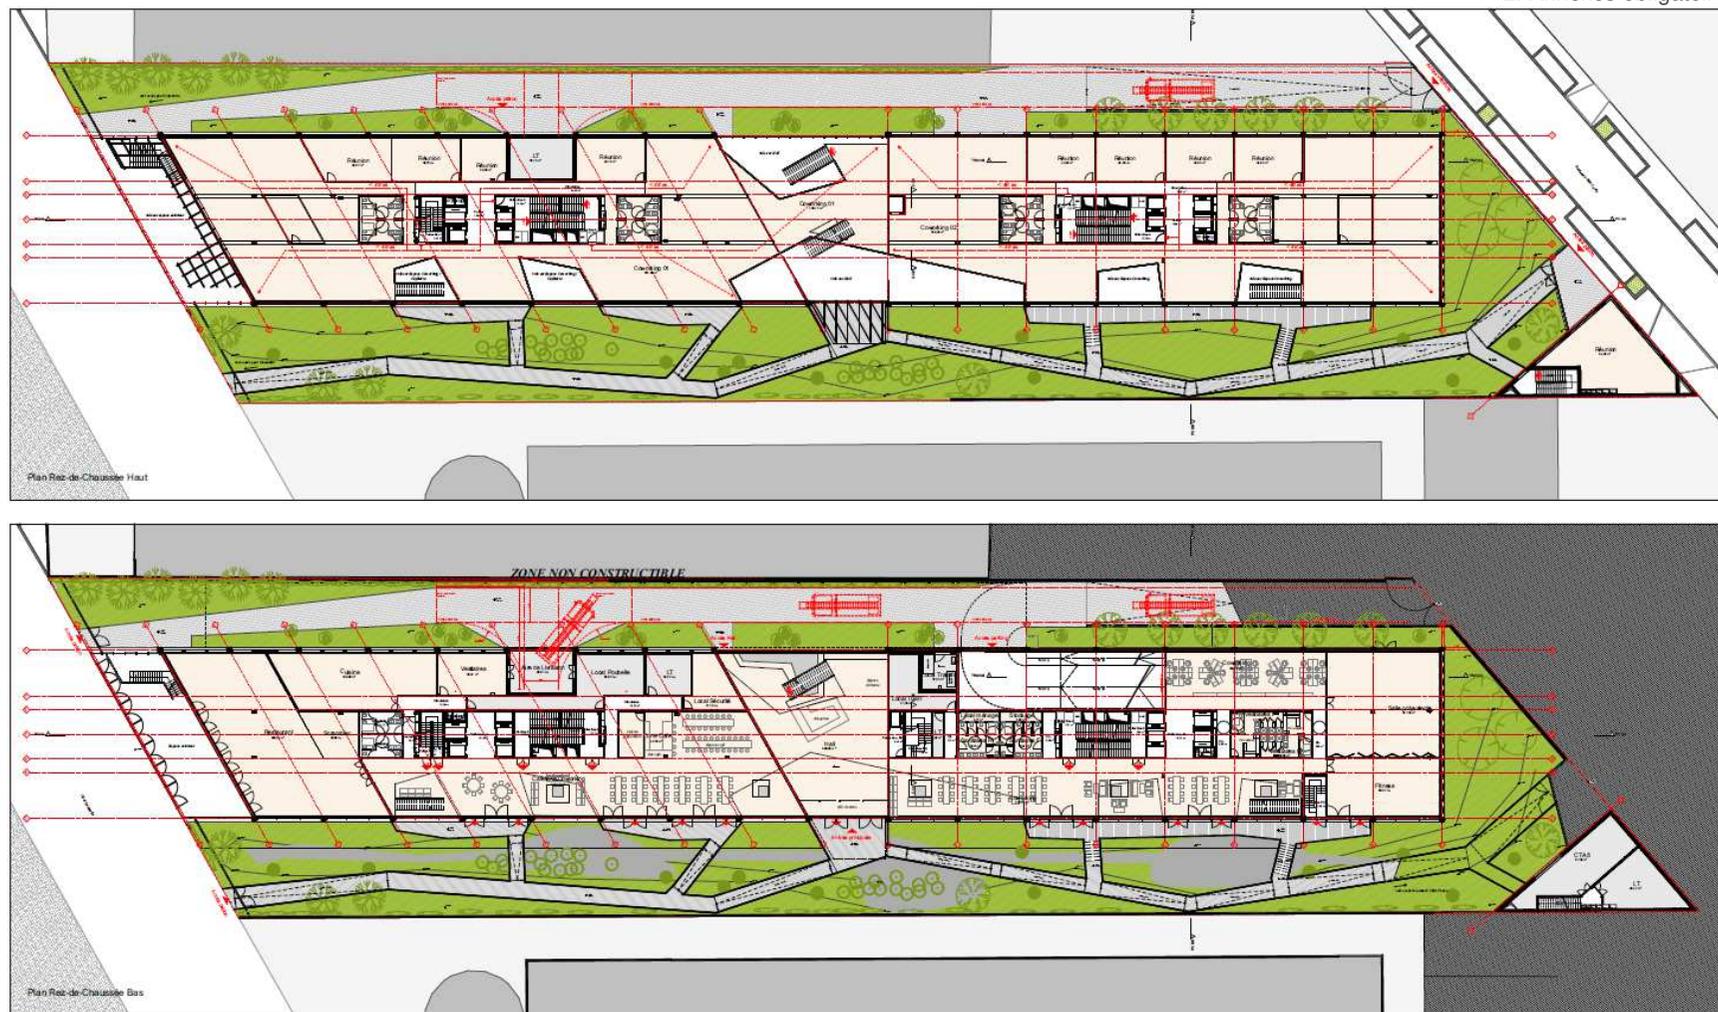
Plan du rez-de-chaussée Bas et du rez-de-chaussée Haut (source : Brenac Gonzalez & Associés, 11/2019)
